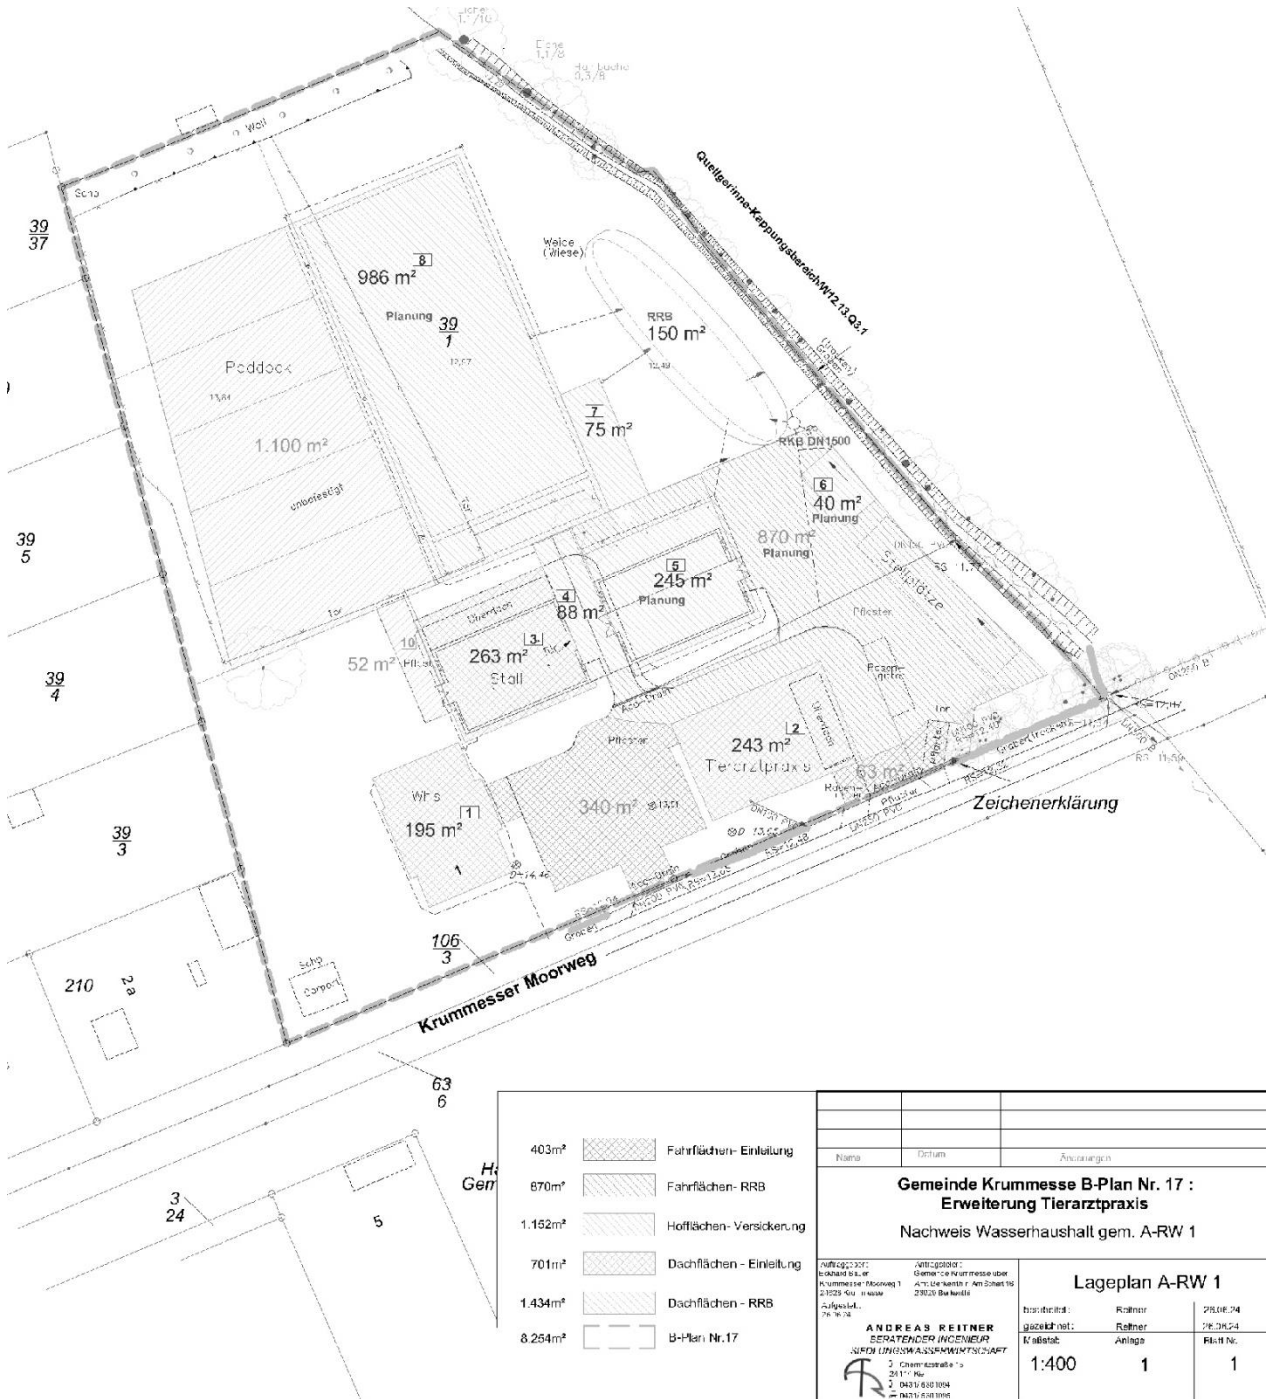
Lageplan zum Nachweis des Wasserhaushalts (Ingenieurbüro A. Reitner, Beratender Ingenieur)
